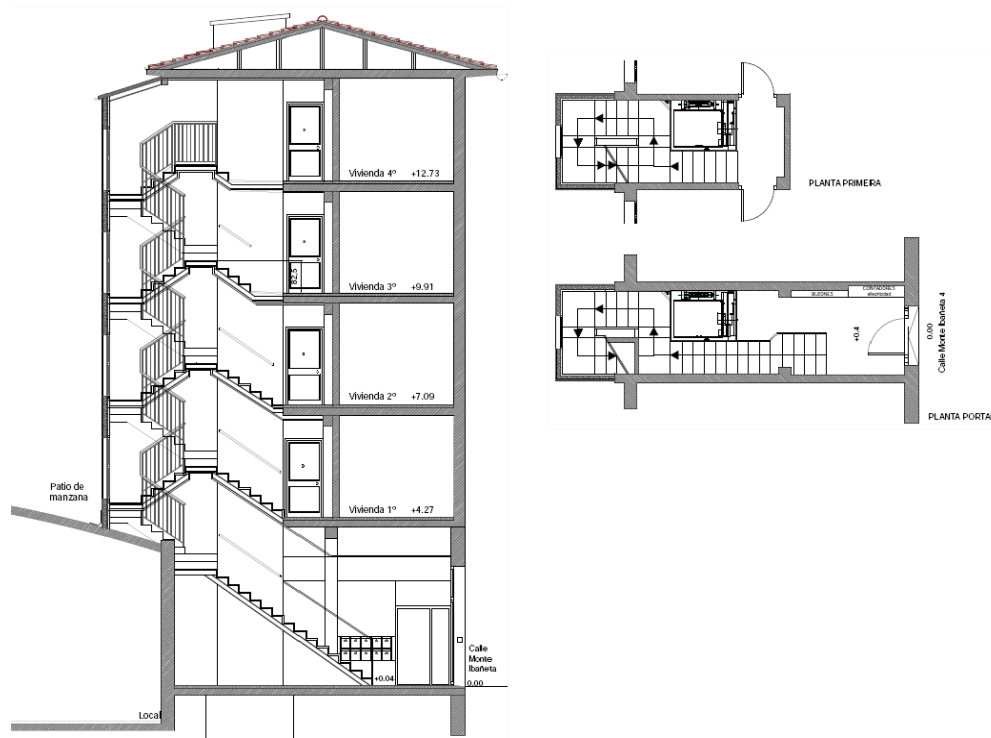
Planos de sección, planta baja y planta tipo de estado reformado del proyecto de rehabilitación con instalación de ascensor en Calle Monte Ibañeta 4 de Pamplona. Fuente propia.
